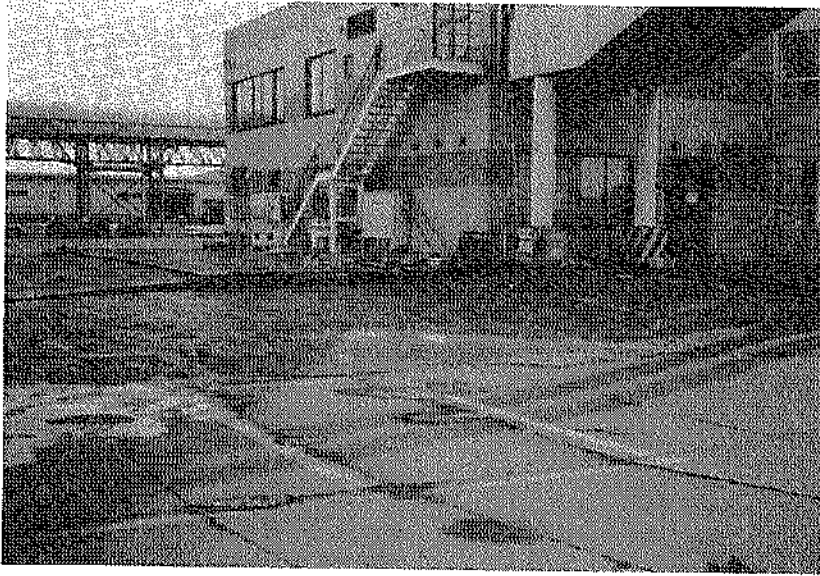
フェリーターミナル基礎周辺の被災状況(第1埠頭地区, ㊤西側岸壁(-9.0m))
